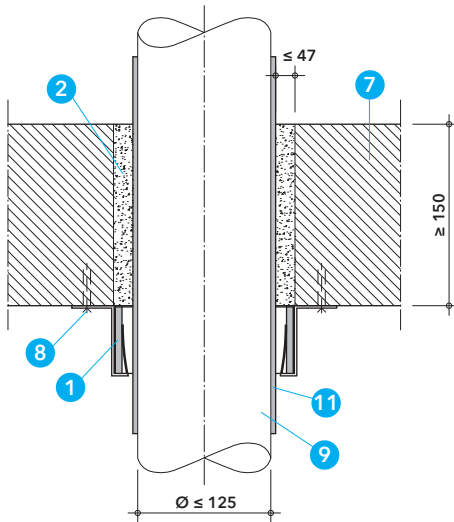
Detail B - prostup plastového potrubí do průměru 125 mm stěnou (alternativa)
